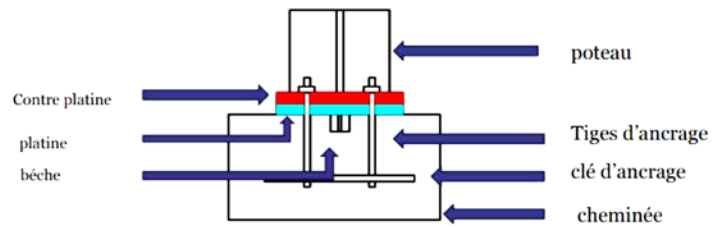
ancrage du pied de poteau métallique dans la fondation.
